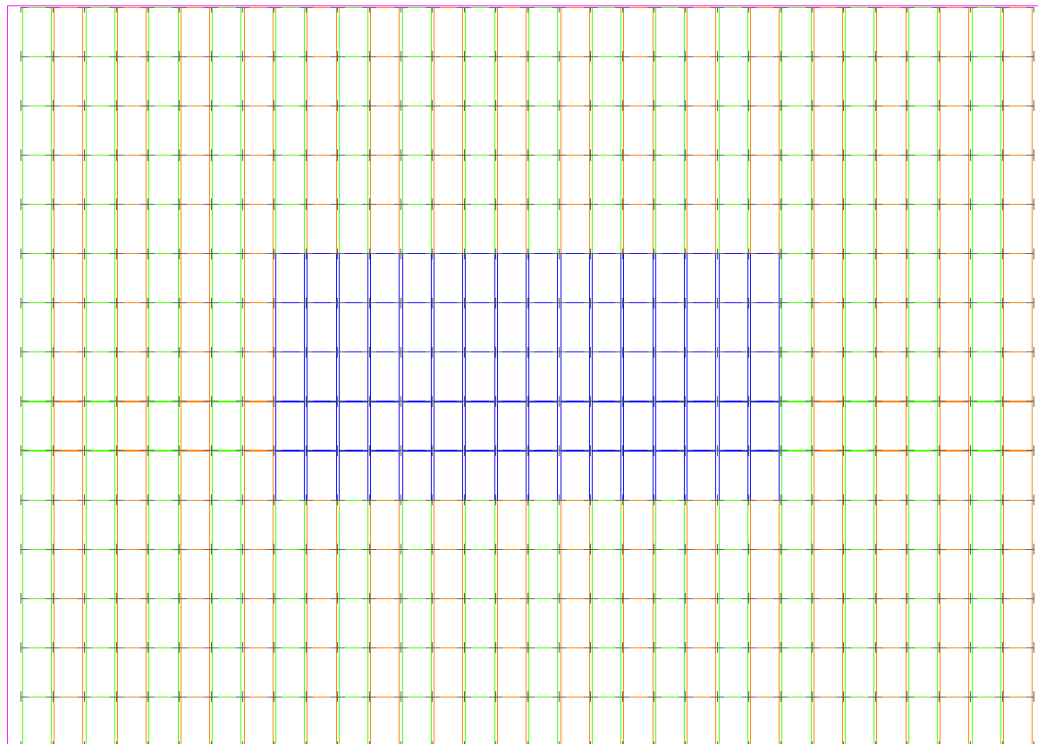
Vista en planta de la plaza Campus Universitario y detalle de las columnas del aparcamiento
